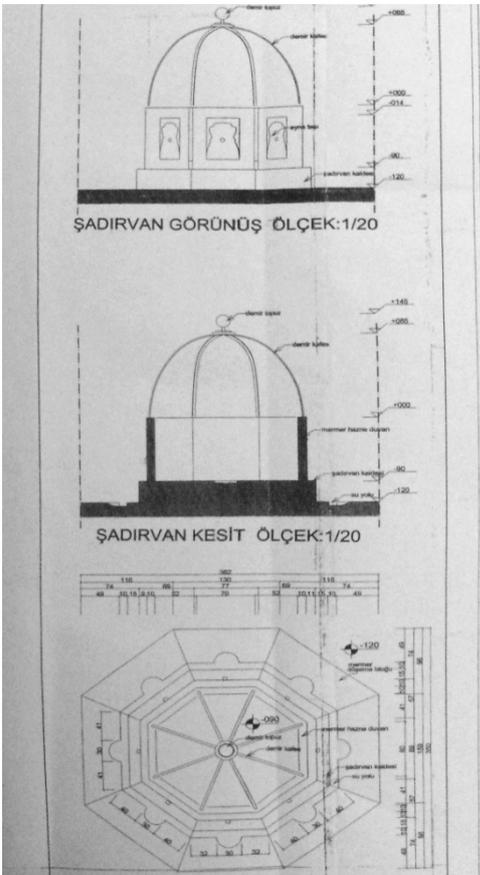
Restaurierungsplan, Ansicht, Schnitt und Grundriss der Brunnenanlage, 2007
